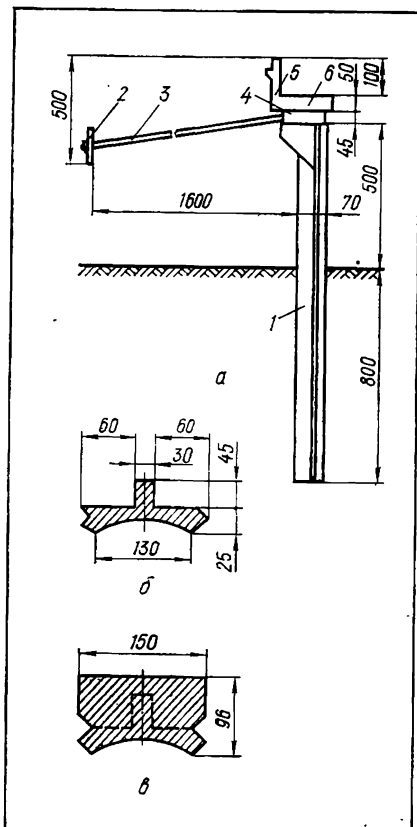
Заанкеренный сборный безростверковый устой шпунтового типа: а — общий вид устоя; б — поперечное сечение отдельной шпунтины; в — то же, у монолитной части; 1 — железобетонная шпунтина; 2 — анкерные железобетонные плиты; 3 — металлический анкер диаметром 56 мм; 4 — монолитный участок; 5 — шкафовая часть опоры; 6 — подферментник.
